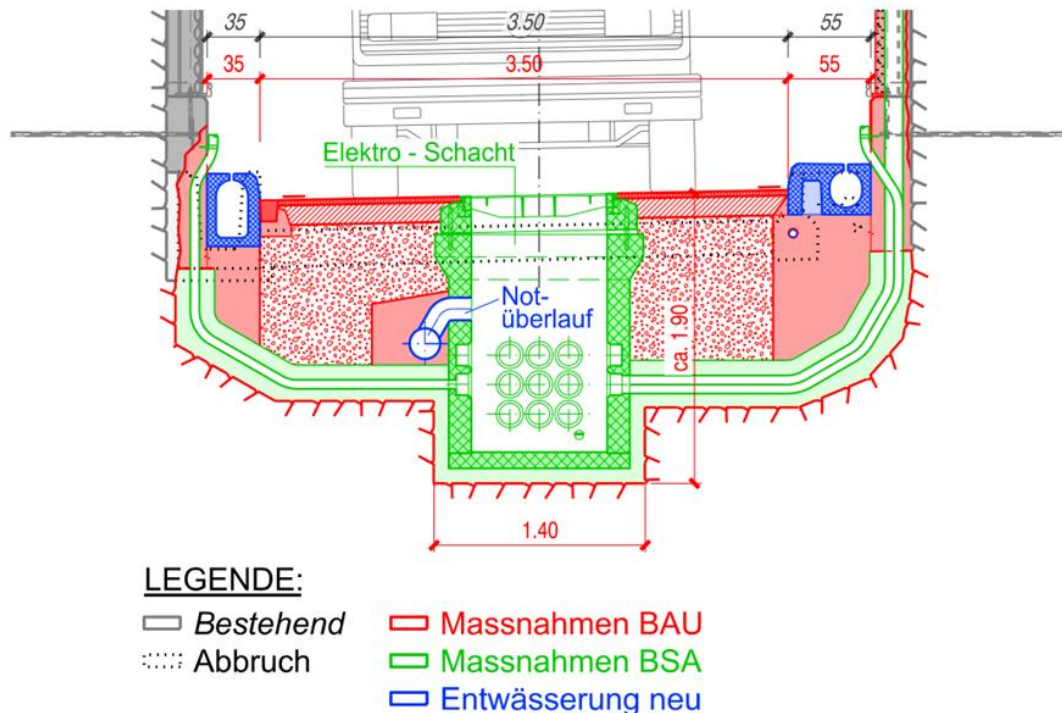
Kabelrohrblock (Massnahmen Betriebs- und Sicherheitsausrüstung BSA) mit seitlichen Abgängen zu den Tunnelinstallationen
